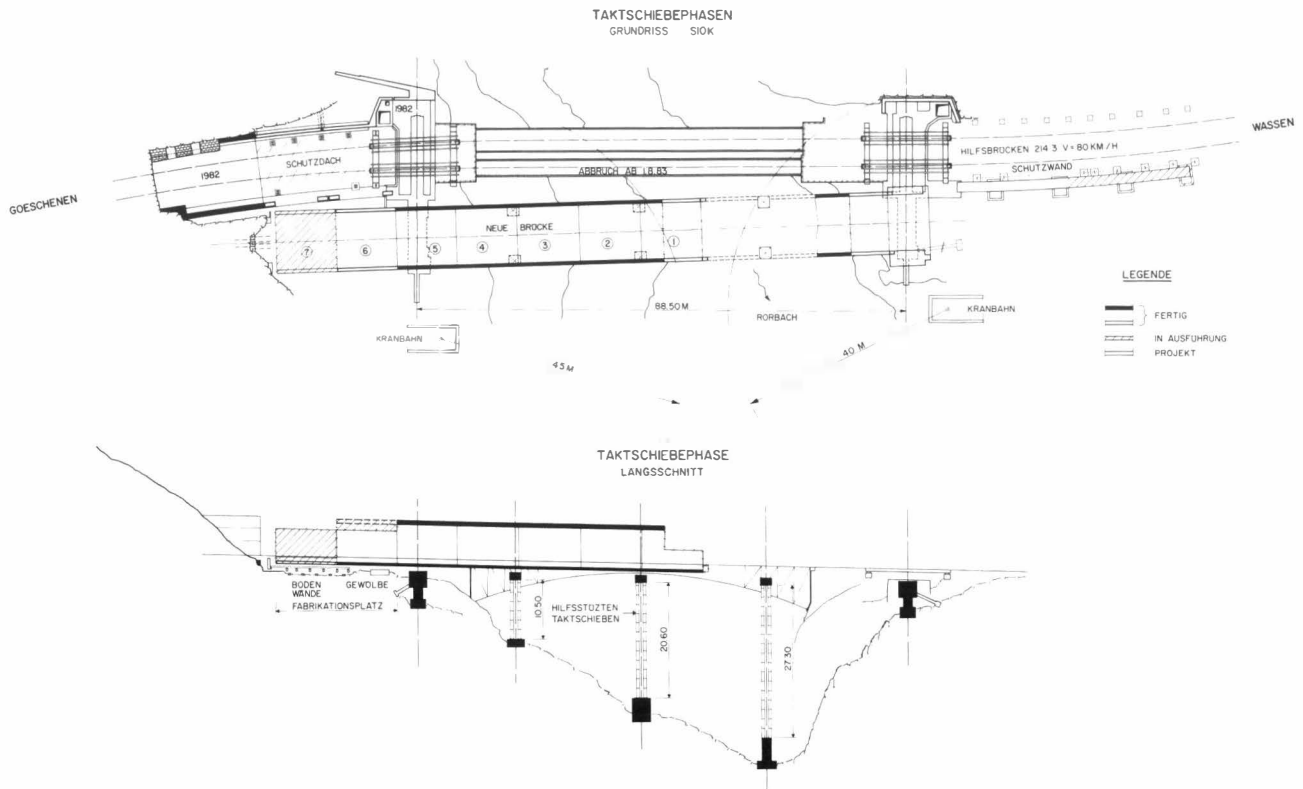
Grundriss und Längsschnitt während des Taktschiebens. Als Vorbauschnabel diente der untere Teil des Querschnittes – Plan et coupe en travers lors du poussage. Le section inférieure de la coupe transversale faisait fonction d'avant bec – Ground plan and longitudinal section during the repetitious pushing stage. The lower cross section part was used as a launching nose
